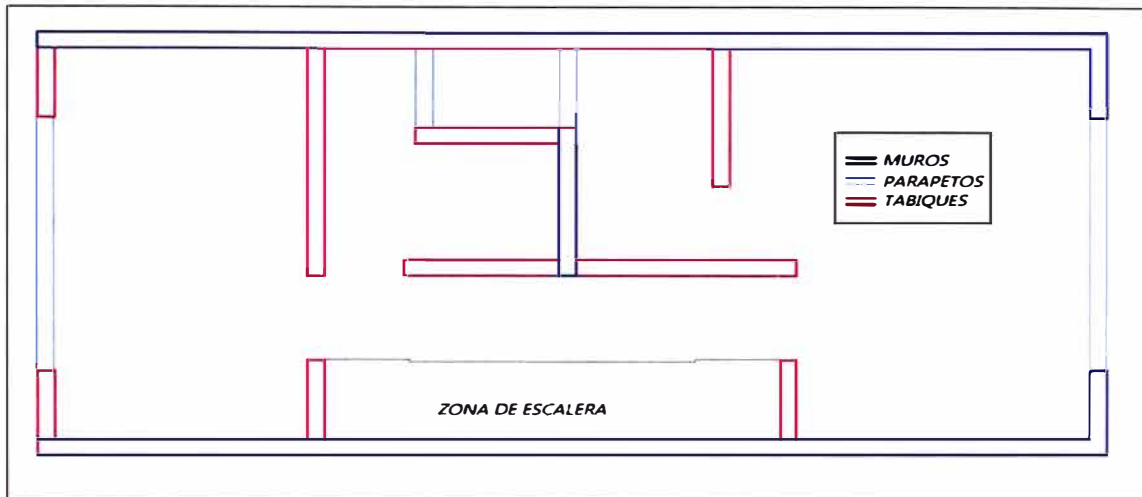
6 .- Distribución en planta de muros estructurales 2º piso.
